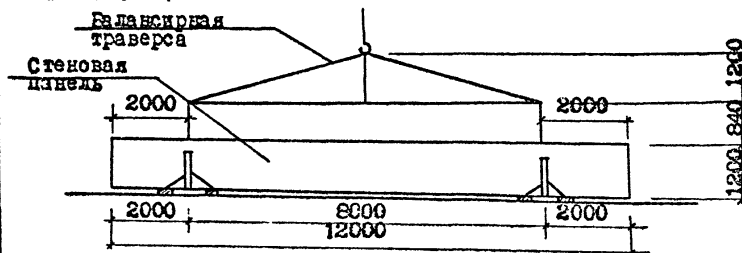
Строповка стеновой панели при разгрузке и монтаже.
